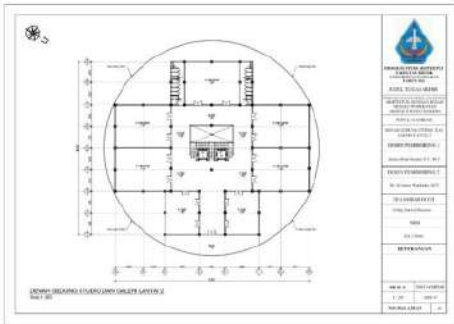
Denah Gedung Fak. Desain Lantai 2
